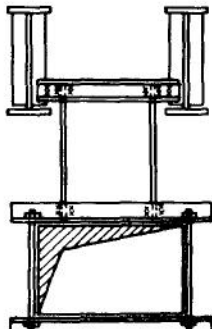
Крепление прямоугольных воздухопроводов к железобетонной колонне с помощью кронштейнов:
